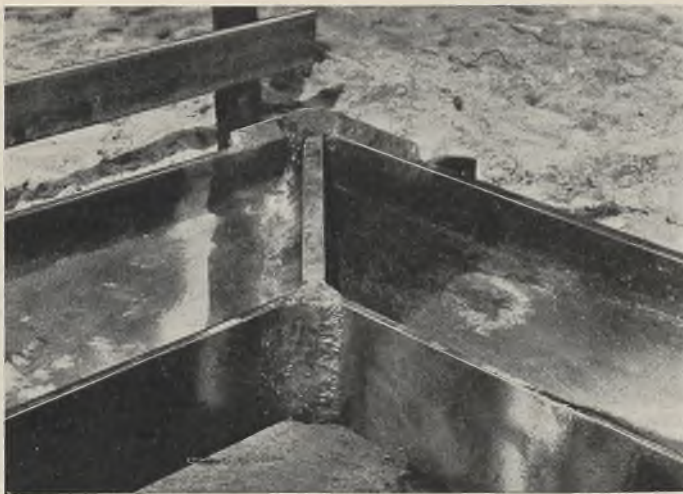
Gasgeschweißte Rahmenecke.
